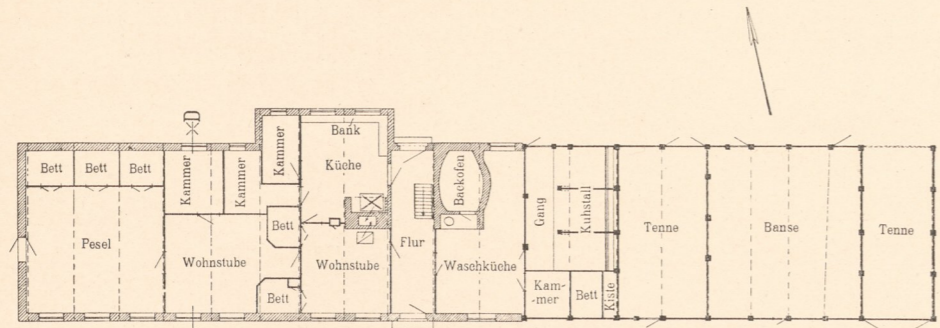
Bauernhaus auf Barsö. Grundriss.
